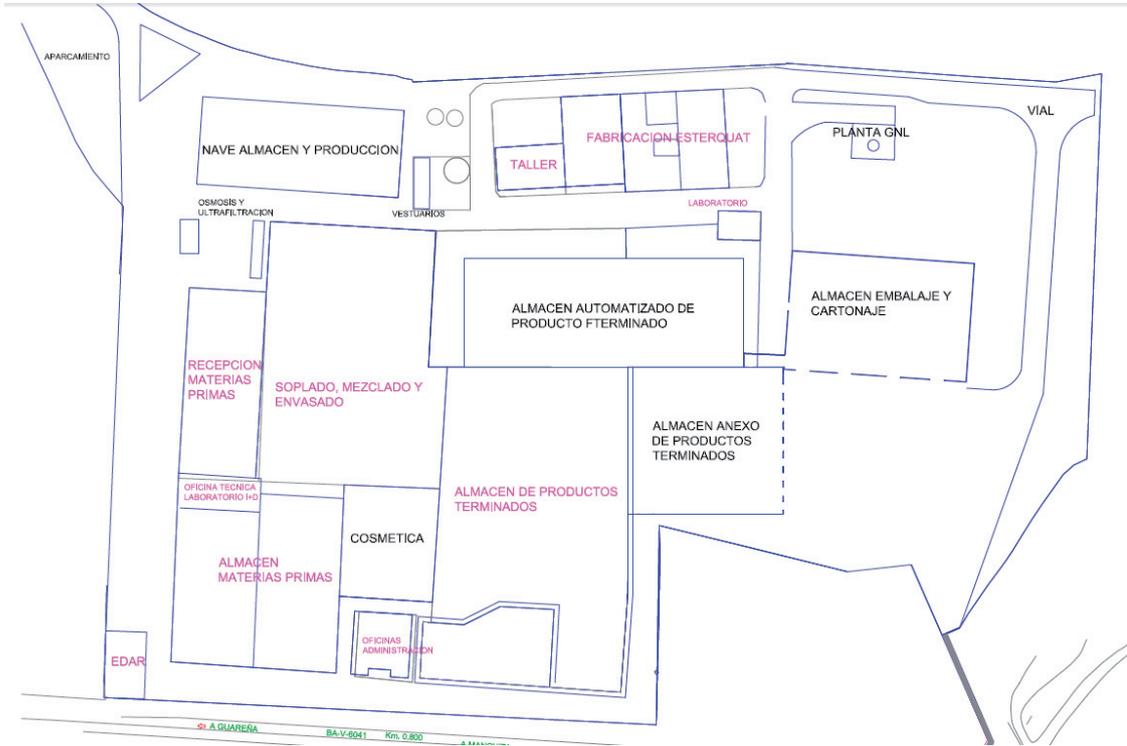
Plano de distribución de las instalaciones y edificaciones principales.
